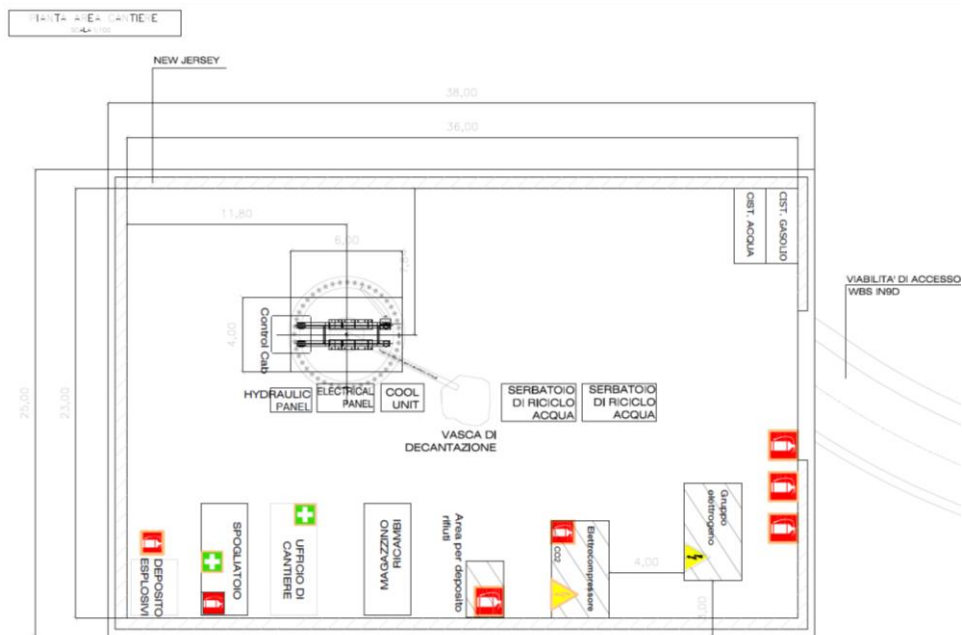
Cantiere pozzo: fase 1 – scavo con rise boring
